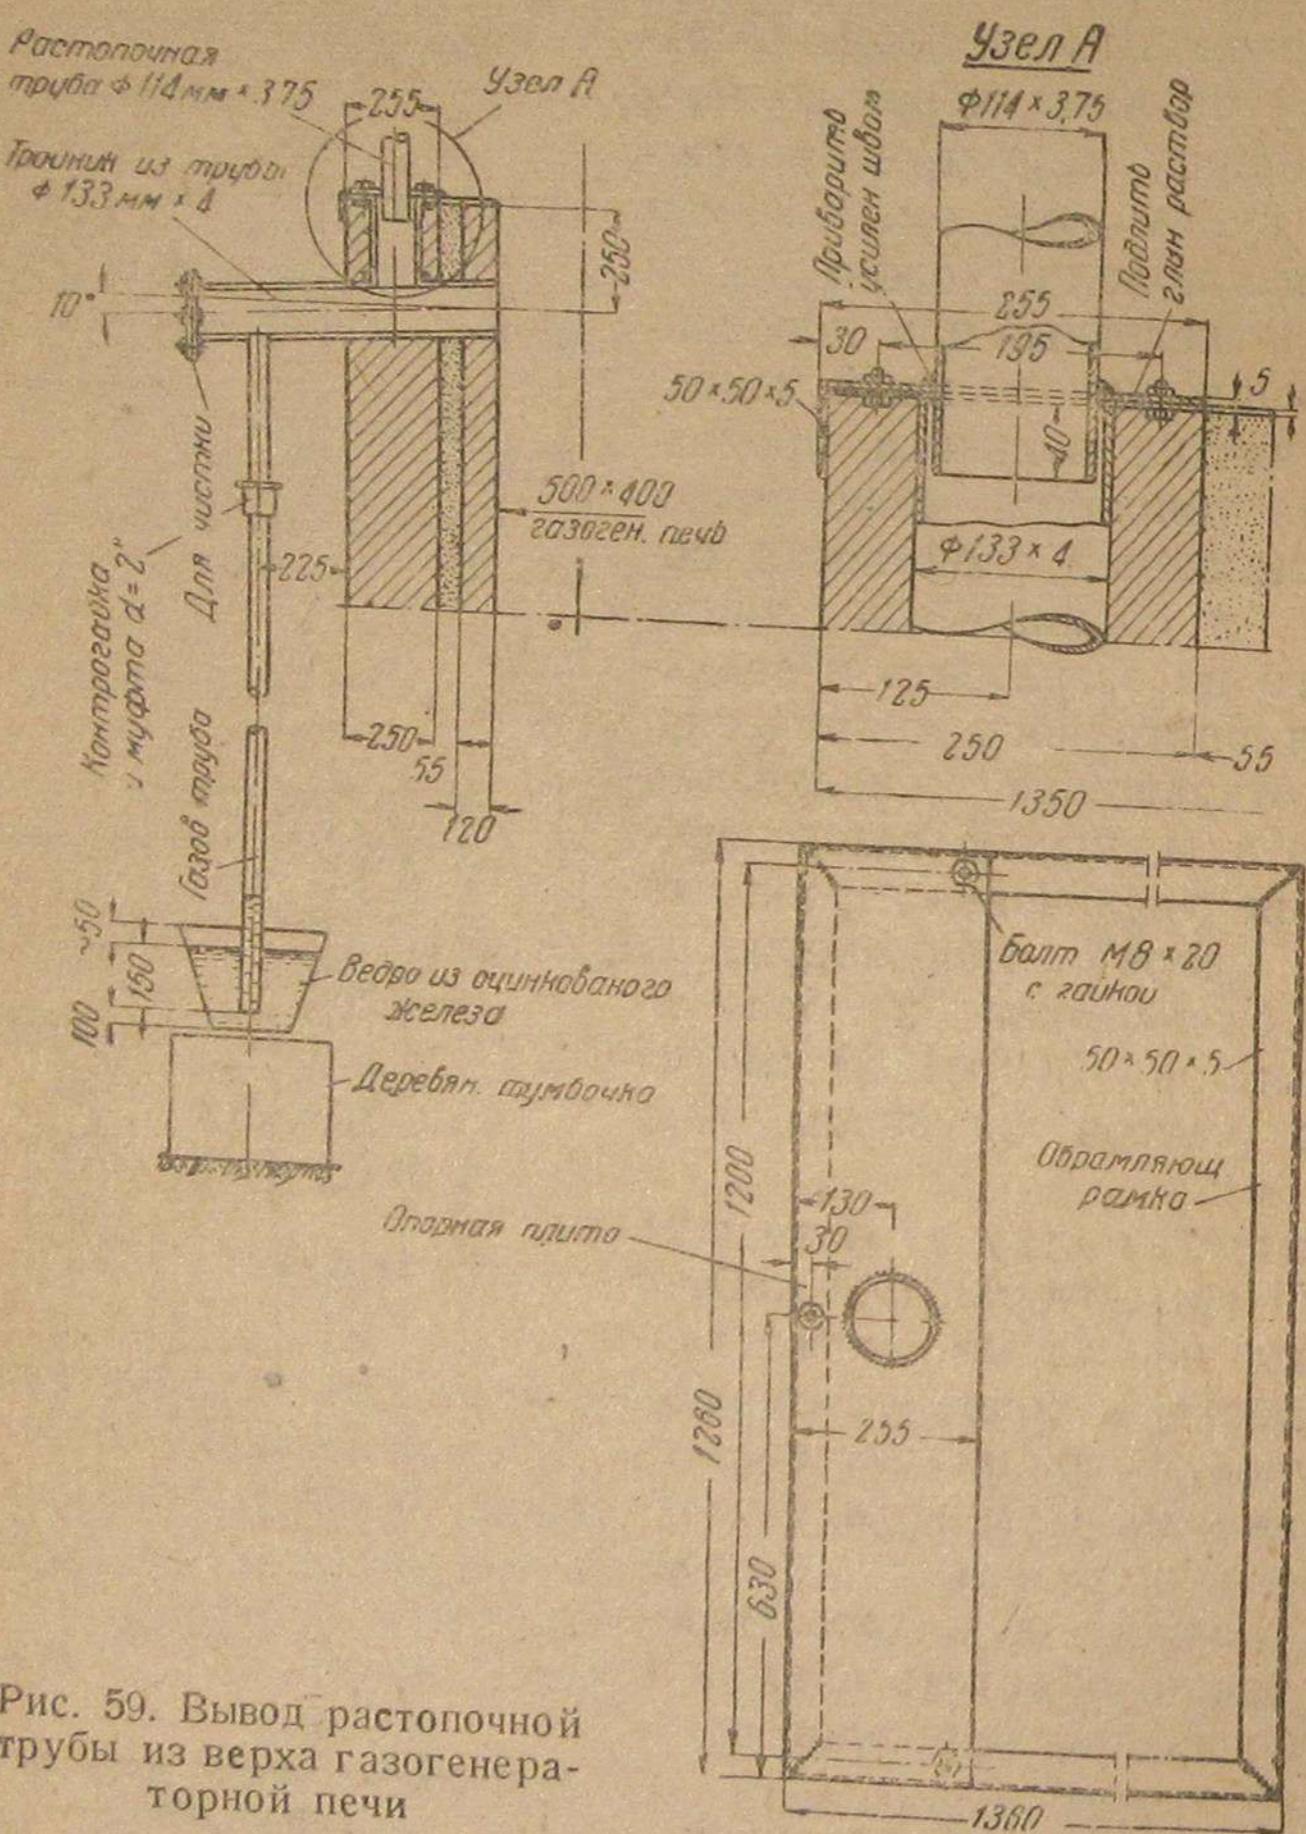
Вывод растопочной трубы из верха газогенераторной печи
